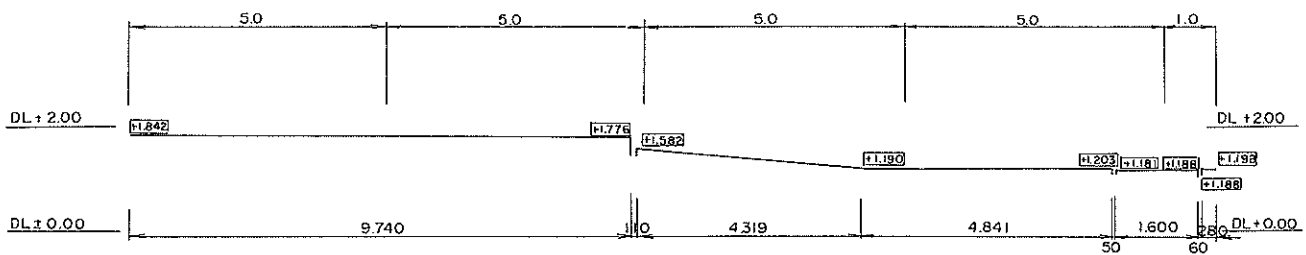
(b) 昭和南1号岸壁被災状況断面図
